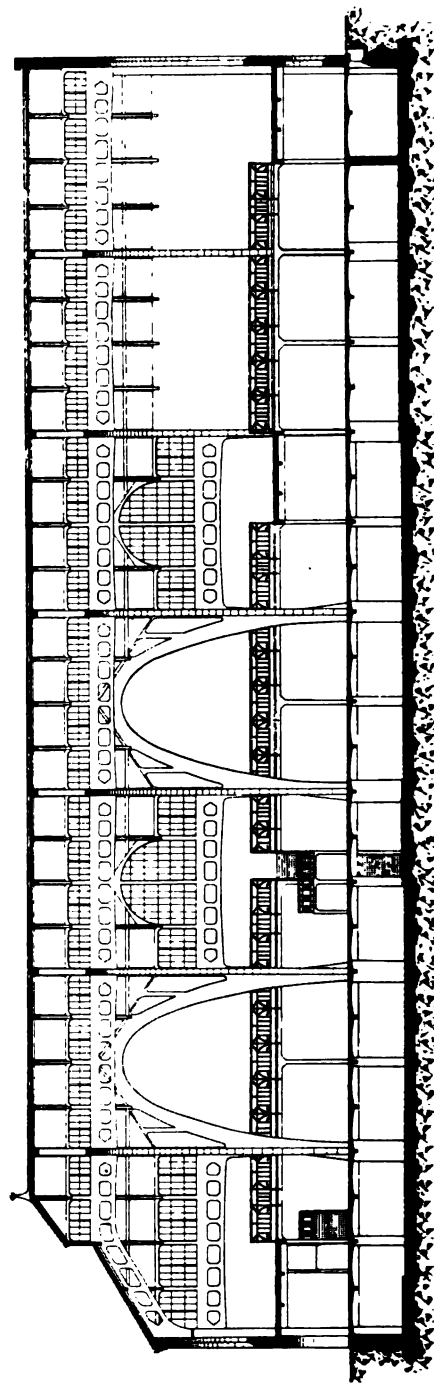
Hauptlängenschnitt (u. Abb. 389).
